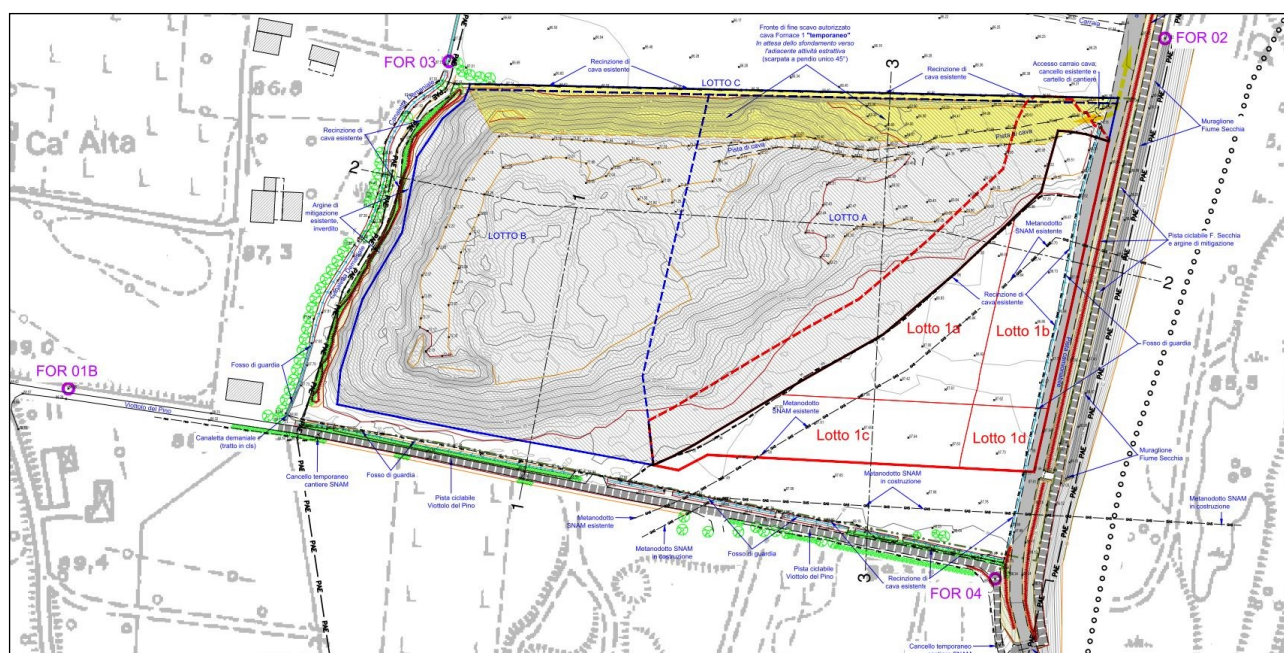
Stralcio Tav. 02 – Stato di Fatto "Planimetria di Rilievo del 16/06/2025".
